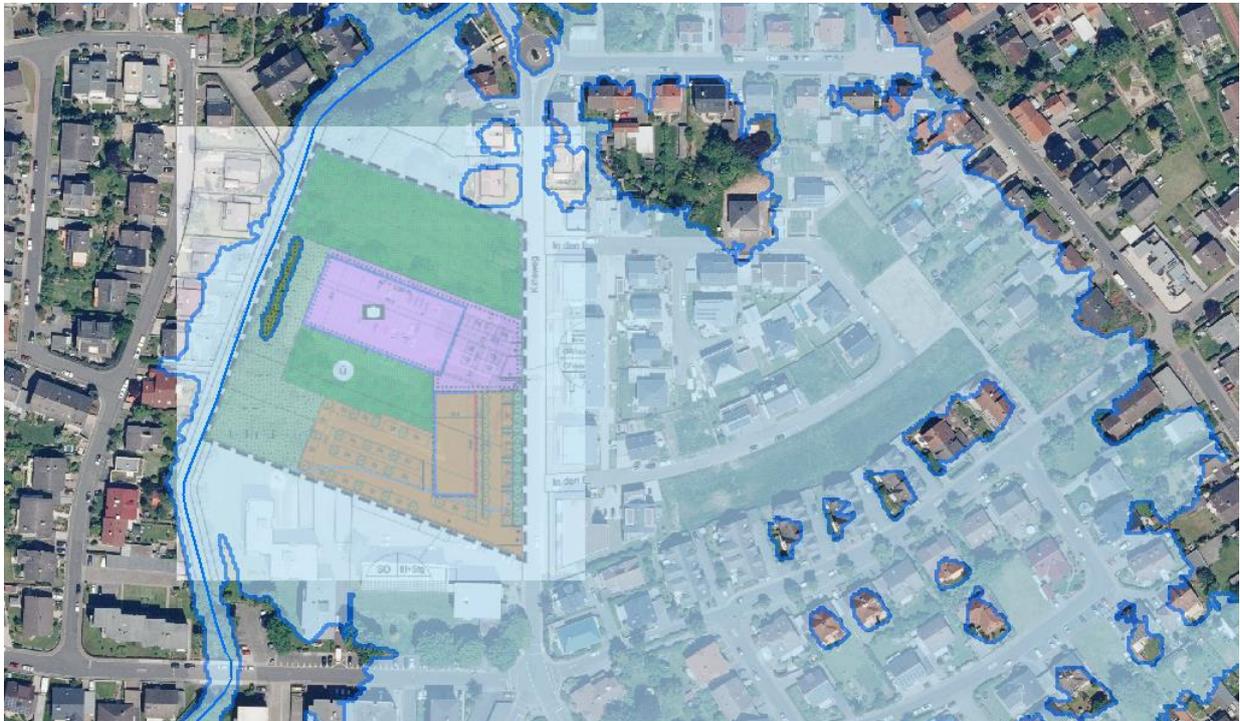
Lageplan der geplanten Bebauung (Quellen: Falkenhahn&Partner; WMS-Dienst Hessen)
